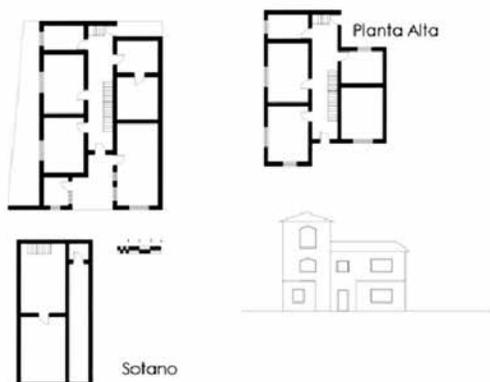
Planta y fachada de la "Casa Bar Alemán".
